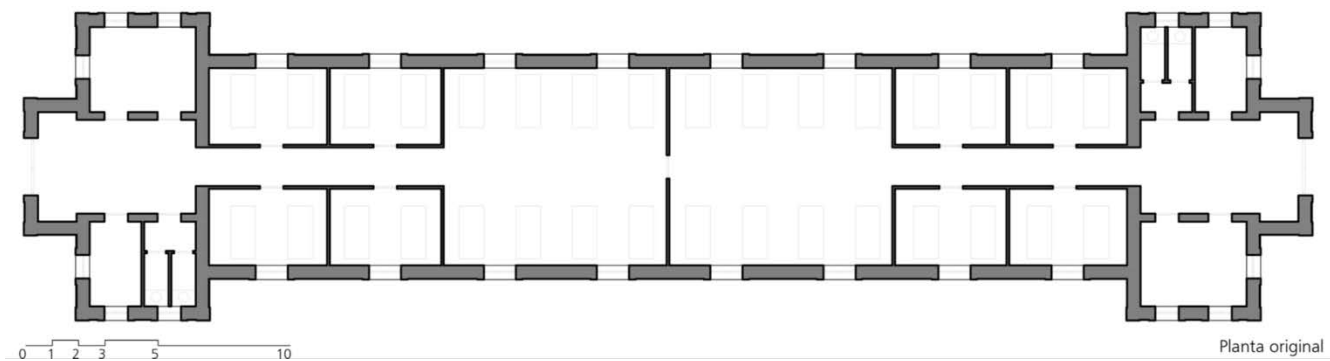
Levantamiento planimétrico del estado original. Sección Horizontal. Escala Gráfica
